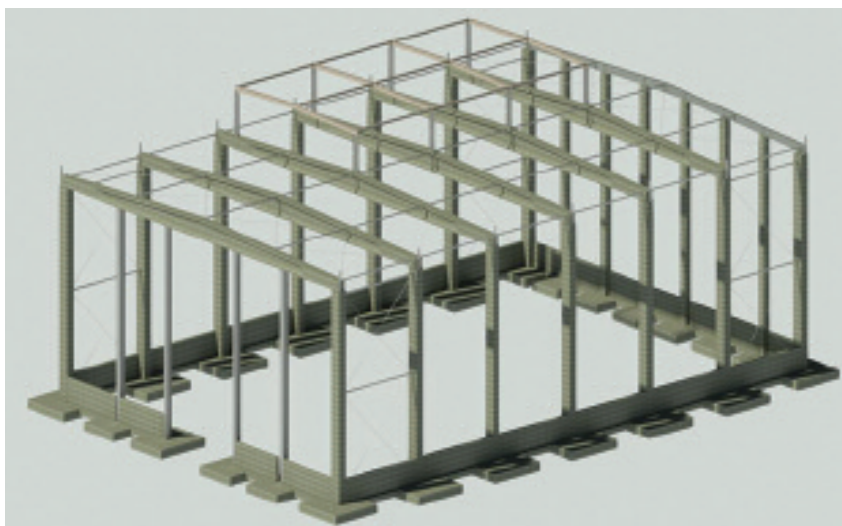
„Zmontowana” cyfrowa konstrukcja. Projekt wykonany w programie REVIT: 1 – dźwigar dachowy; 2 – belka dachowa; 3 – podciąg; 4 – słup
